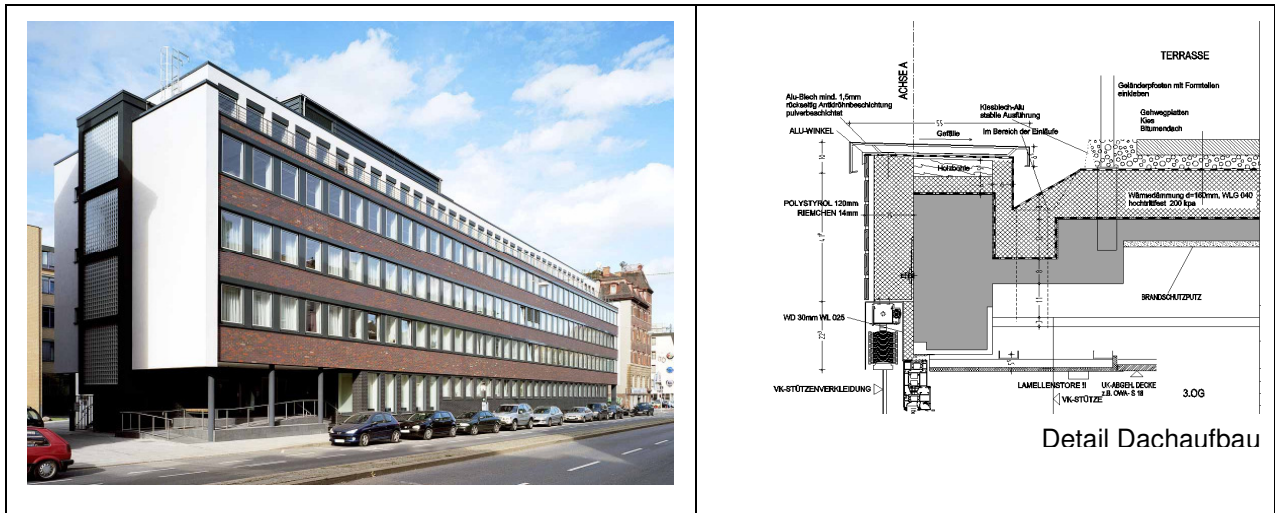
4: Ansicht und Detailschnitt Fassade/Dachaufbau [Quelle: Ed. Züblin AG].
